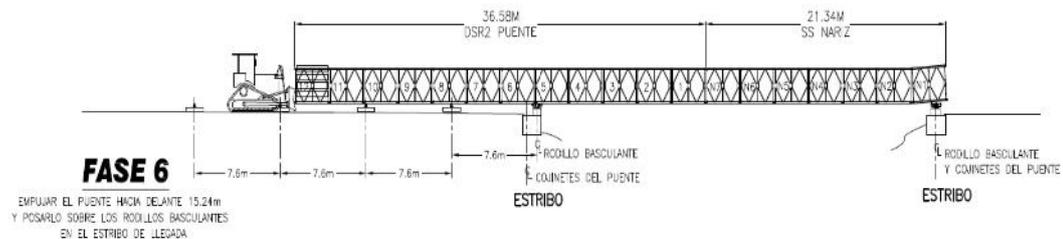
Lanzamiento de estructura hasta alcanzar el otro estribo (Fuente: Acrow Corporation)
